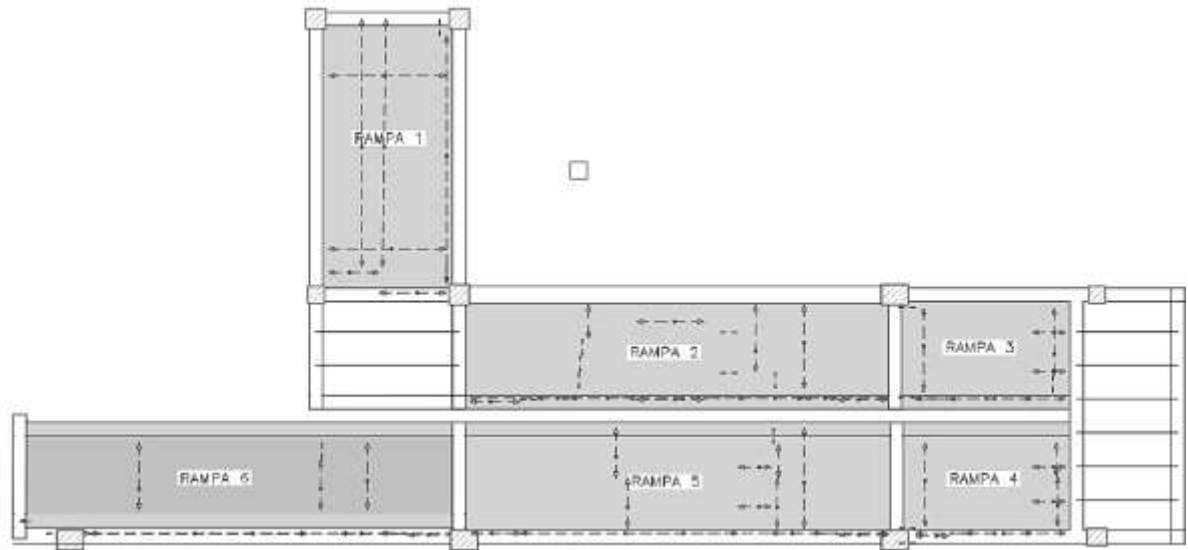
Vista en planta de las rampas, Fuente: Elaboración Propia.
